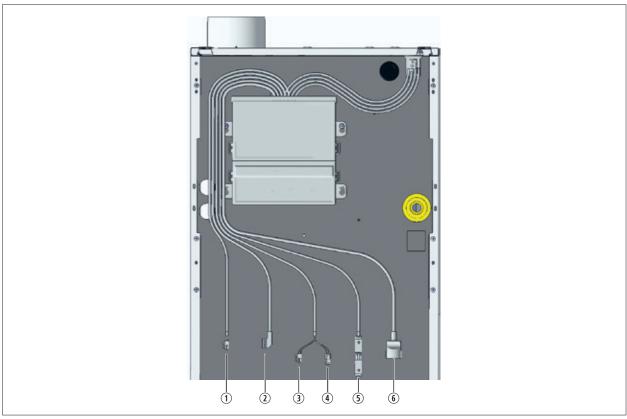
Raccordement électrique à l'arrière de la chaudière à fioul
